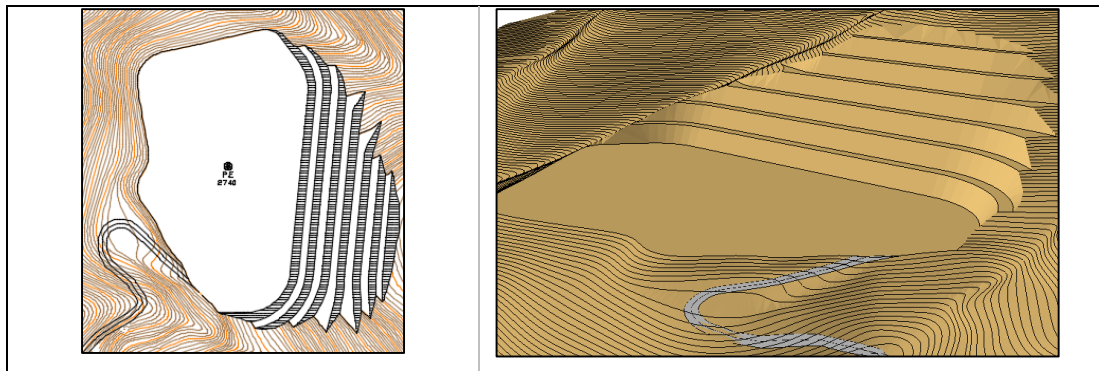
Vista en planta y en 3D de la Fase 7 de explotación.
